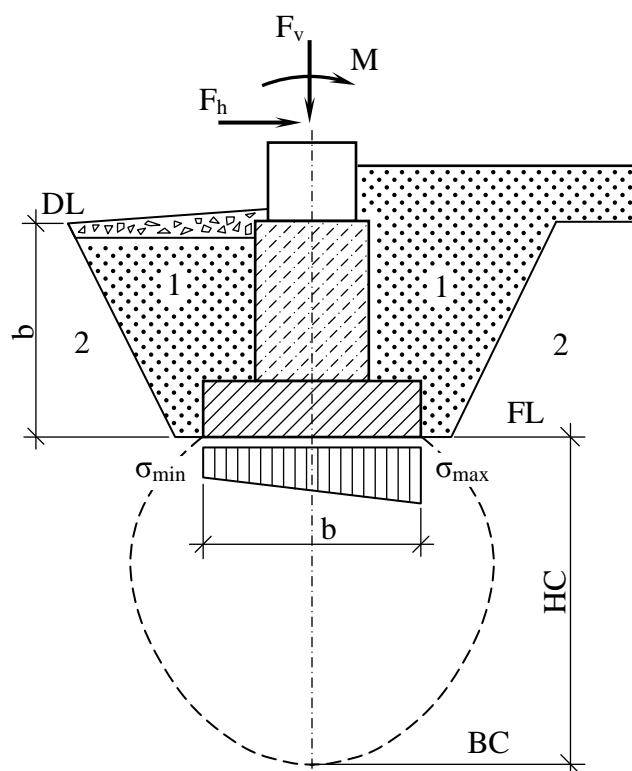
Схема взаємодії фундаменту, споруджуваного у відкритому котловані, з навколишнім ґрунтом:
